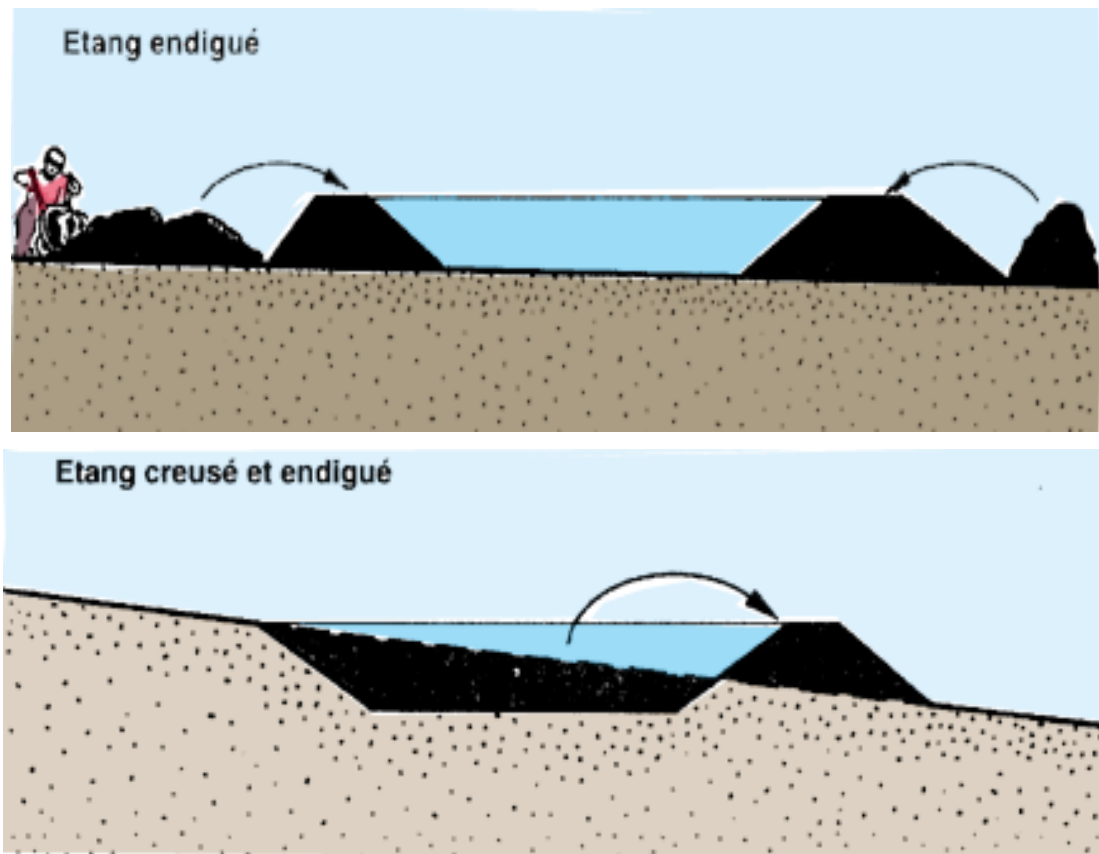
les étangs selon les techniques de construction (FAO, 2006).
